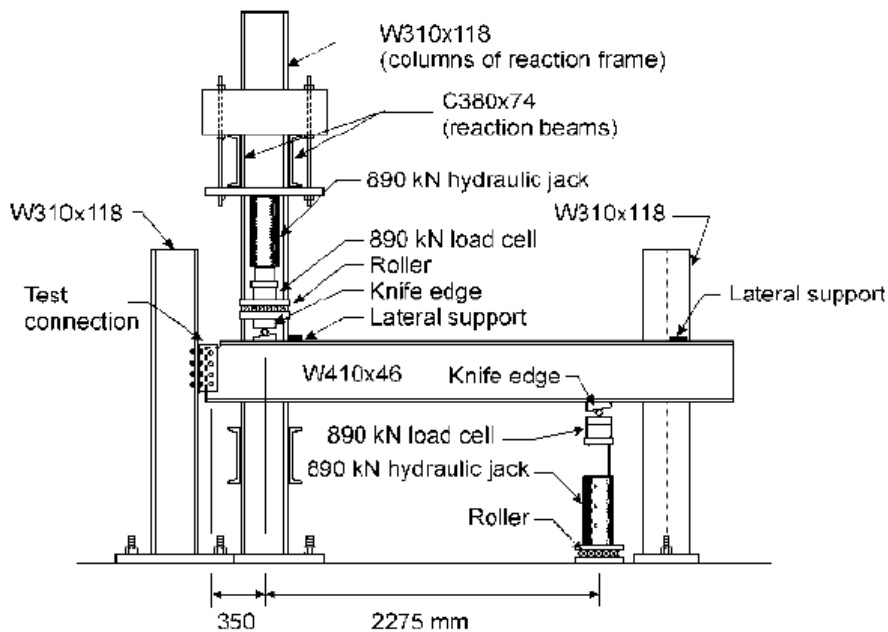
Modelo de Ensayo, Falla en Bloque de Corte en Vigas de acero.
